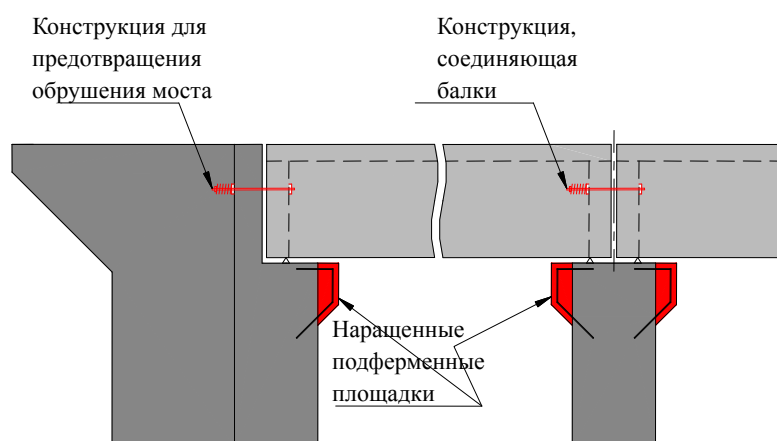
Схематический чертеж конструкции, соединяющей балки, конструкции для предотвращения обрушения моста, а также наращенных подферменных площадок
